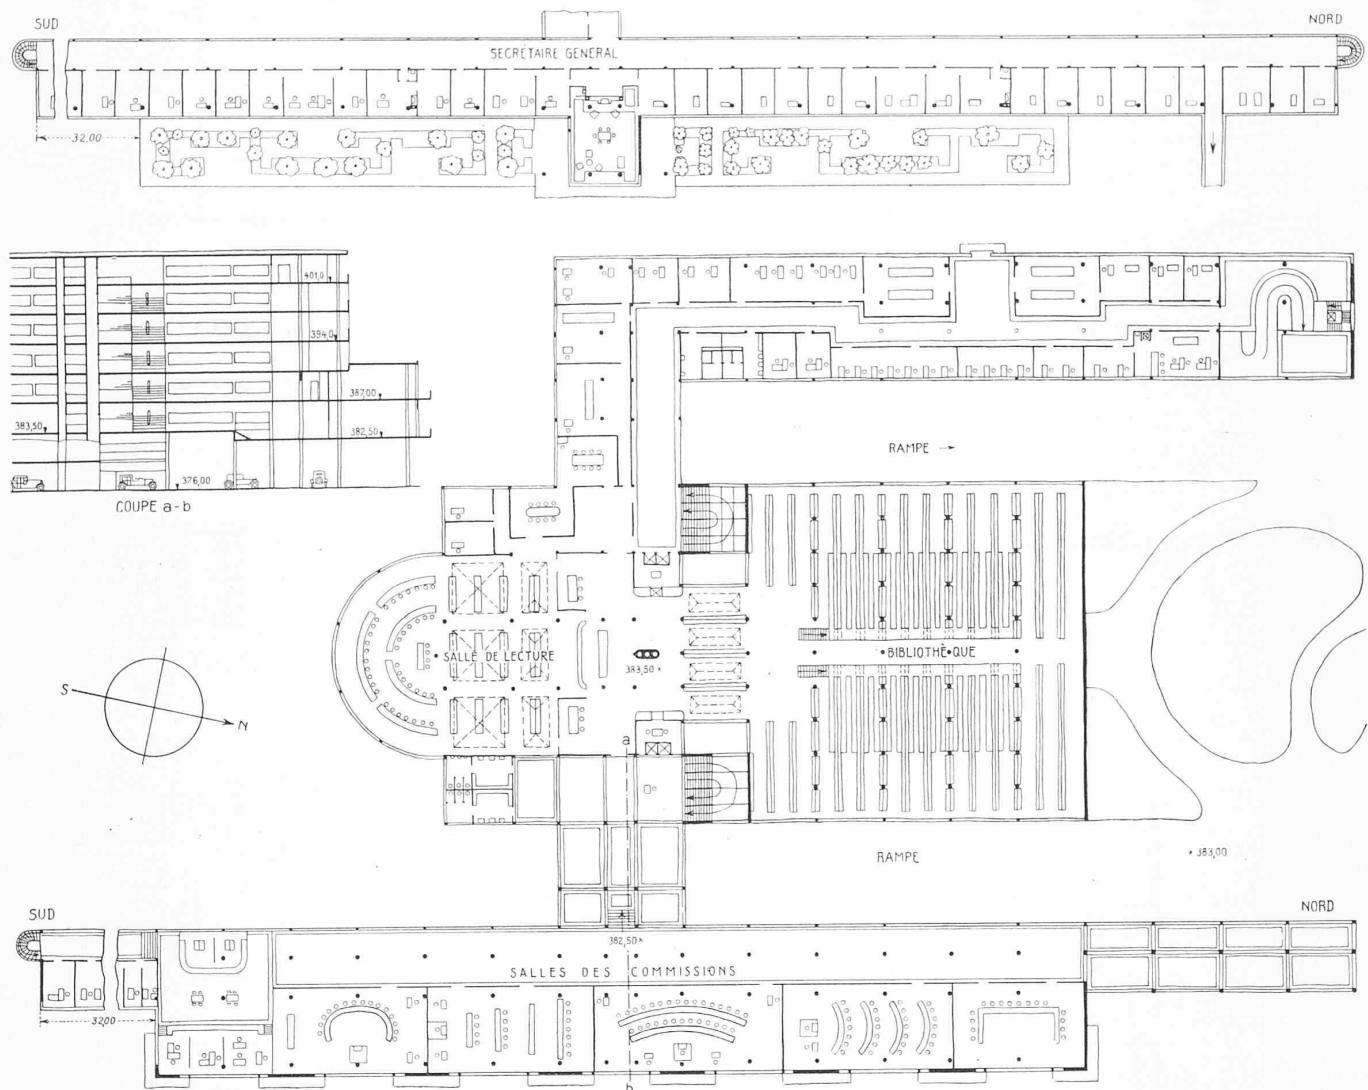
und 10. Grundrisse und Schnitt des Sekretariat-Gebäudes und der Bibliothek; hinterster Flügel Verwaltung. — Masstab 1 : 800.
